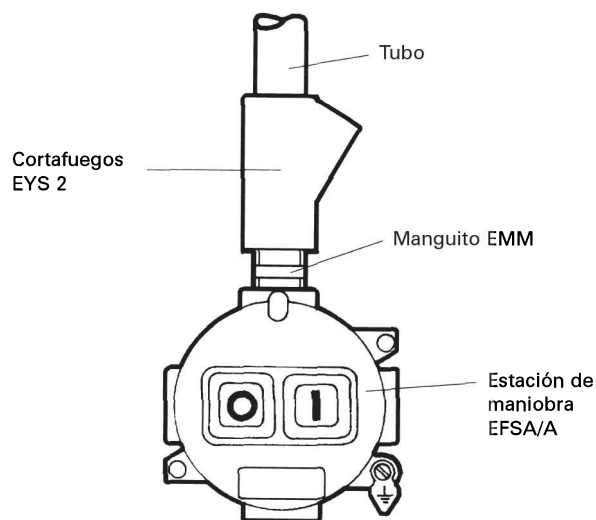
Montaje de cortafuego junto a elemento de mando.
